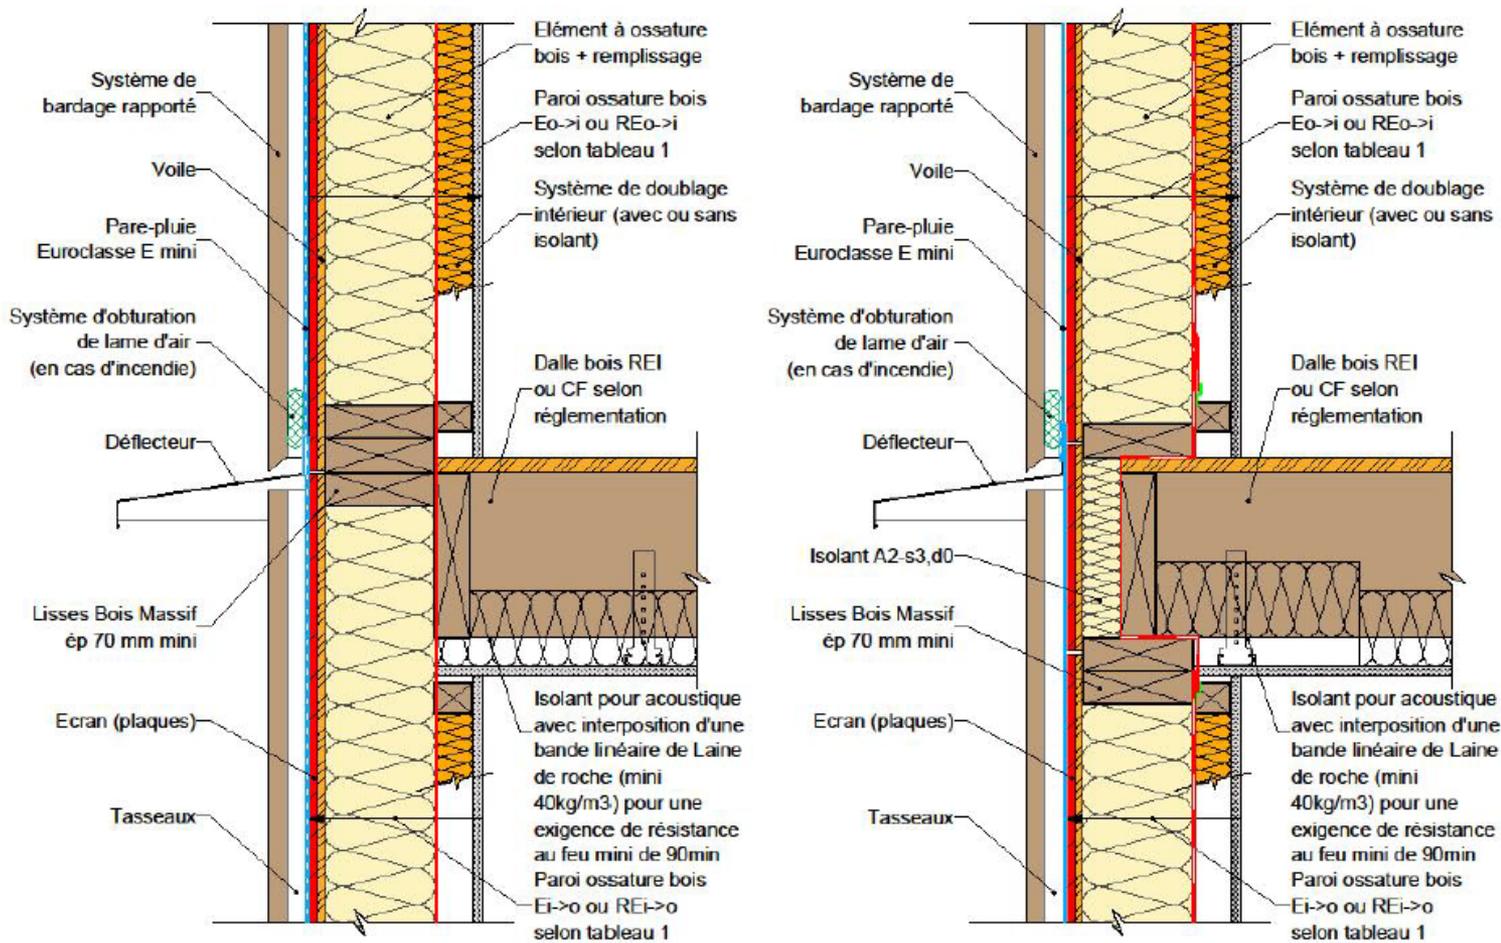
Façade/mur ossature bois & plancher en ossature bois.
